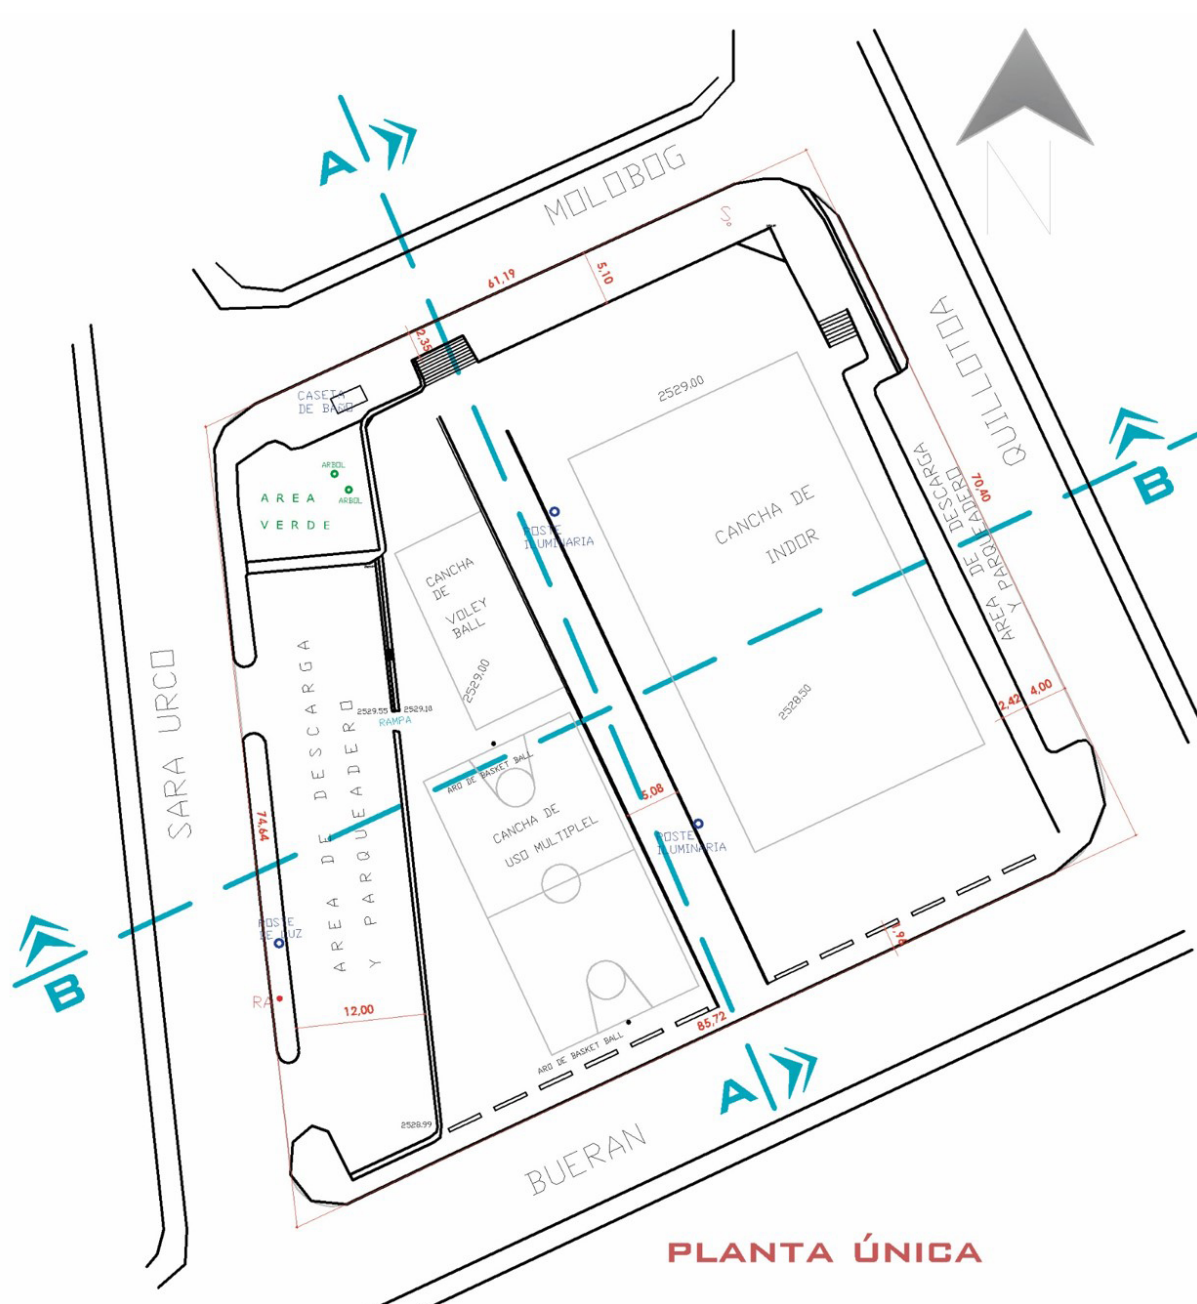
Levantamiento Planimétrico, planta única. Fuente: Fabrizio Benenaula.
